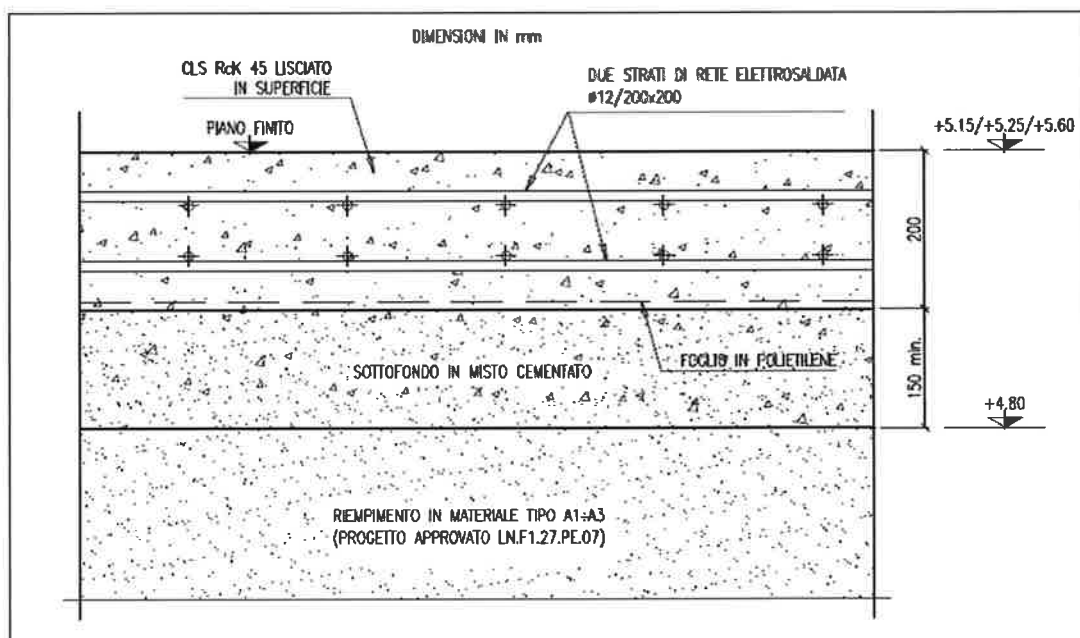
DETTAGLIO PAVIMENTAZIONE IN C.A. PIAZZALE IMPIANTI
